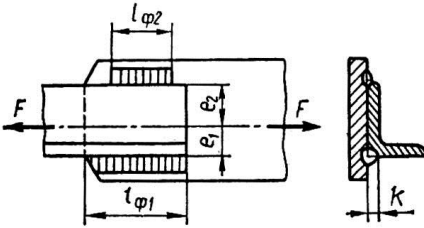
Схема до розрахунку зварного з'єднання кутника з косинкою
